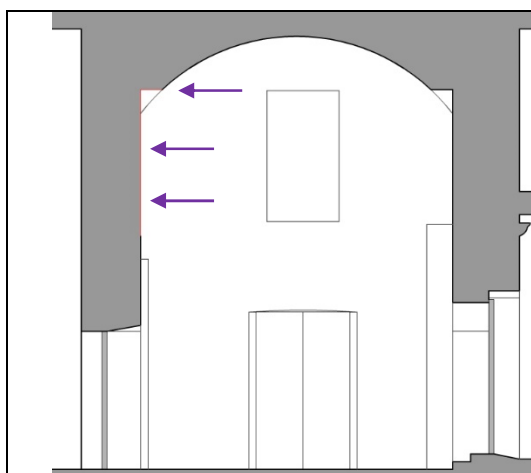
Detalle grieta alzado-sección Biblioteca
